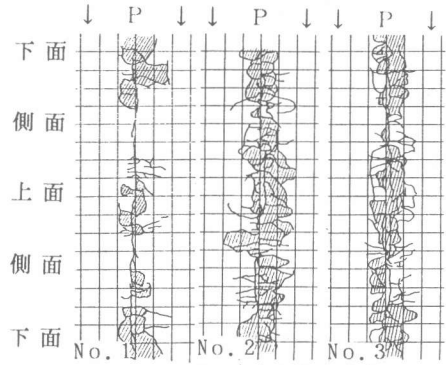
ひび割れ形状図(荷重中央部展開図)
